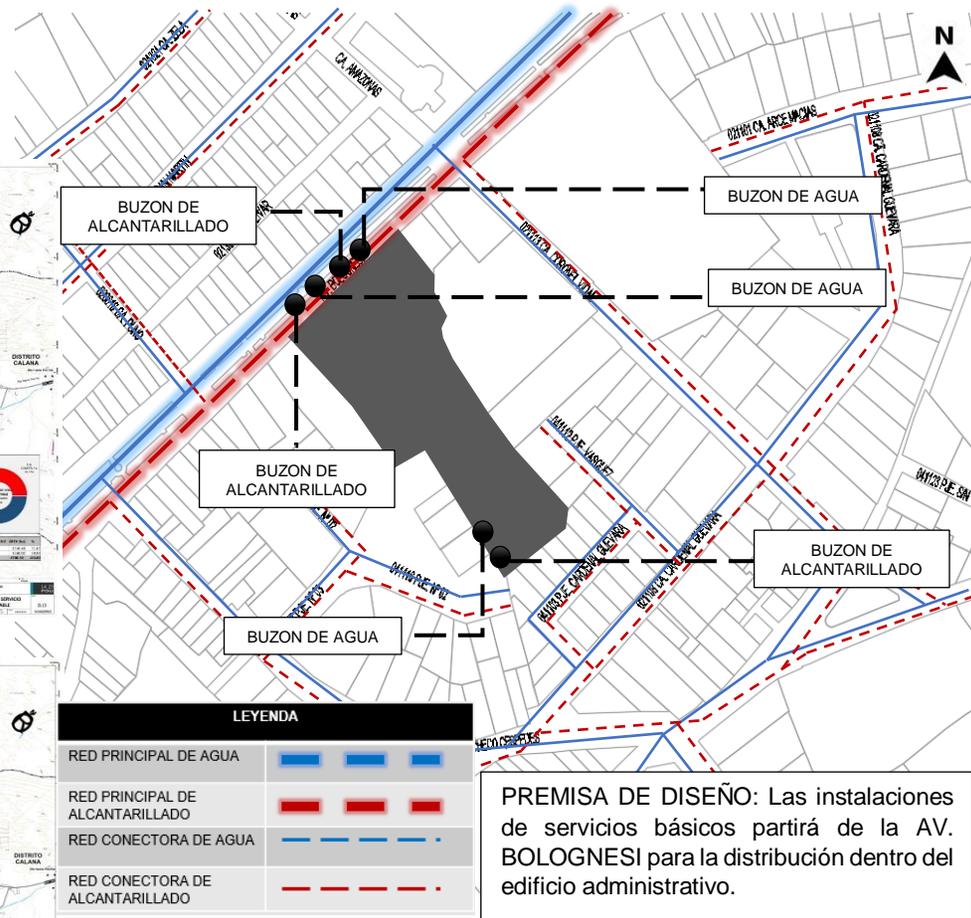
Plano de Servicio de Agua y Alcantarillado
